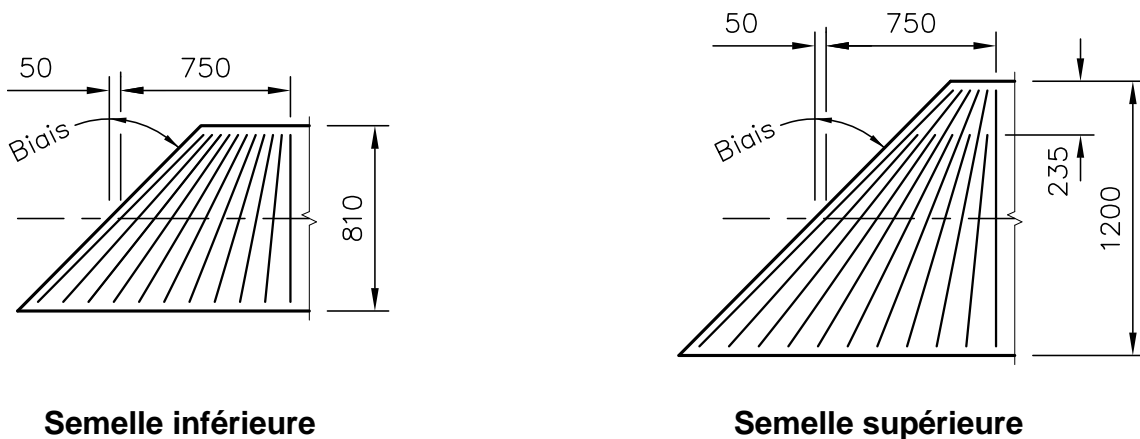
Disposition des armatures transversales aux extrémités des poutres avec biais entre 30° et 45°
